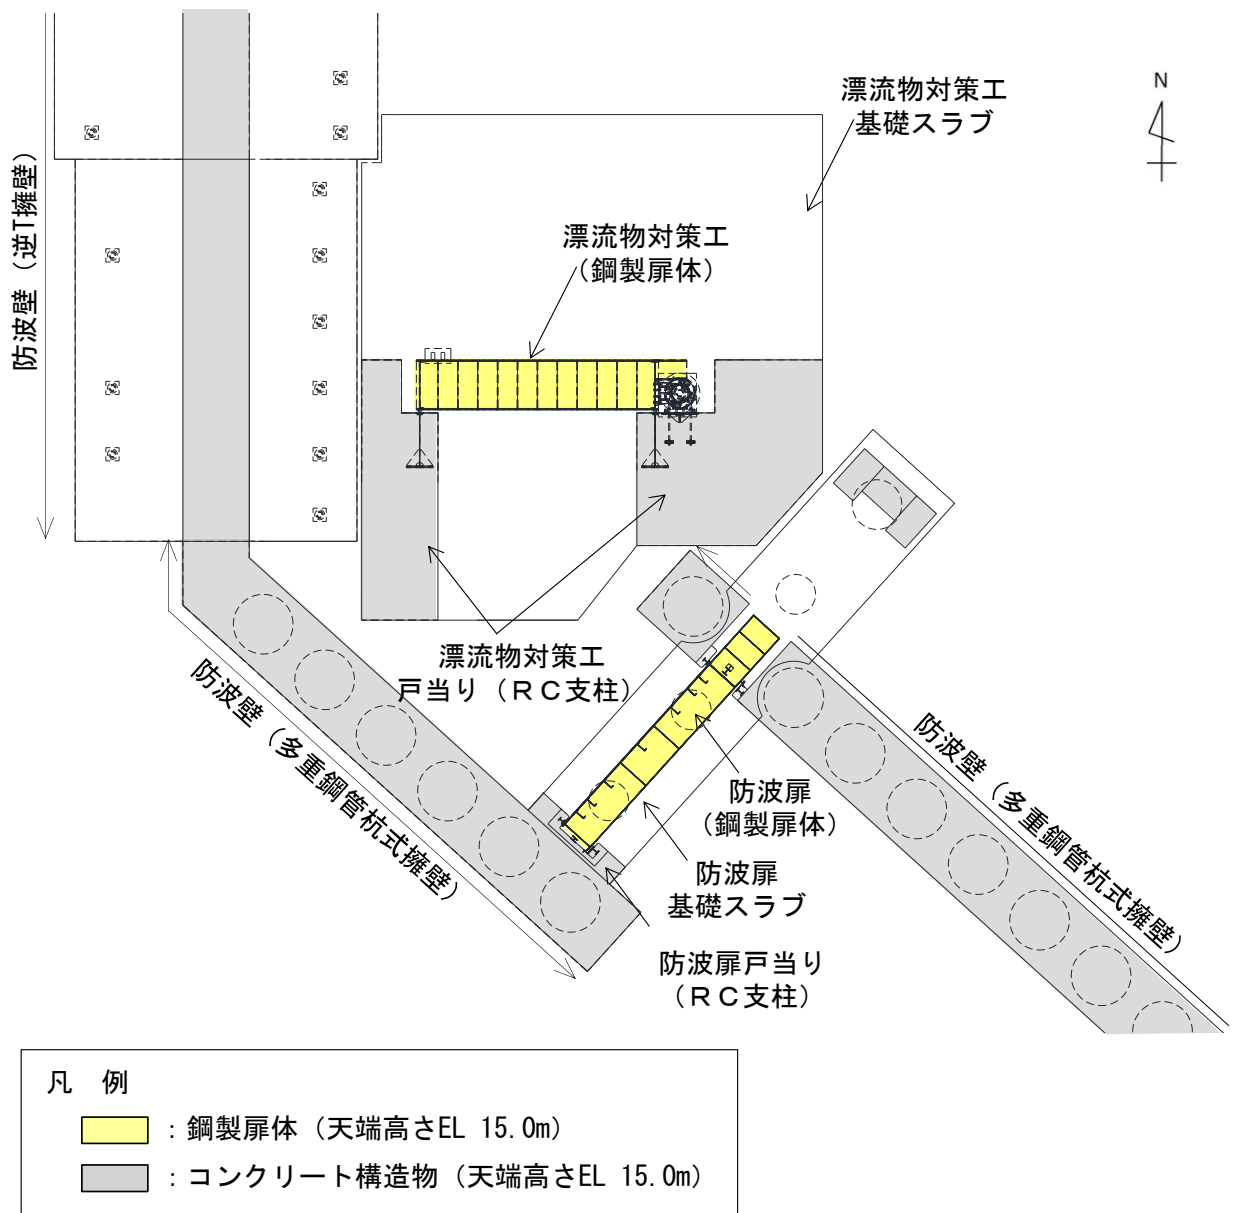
(2) 防波扉 (荷揚場南) の構造概要図 (平面図)
